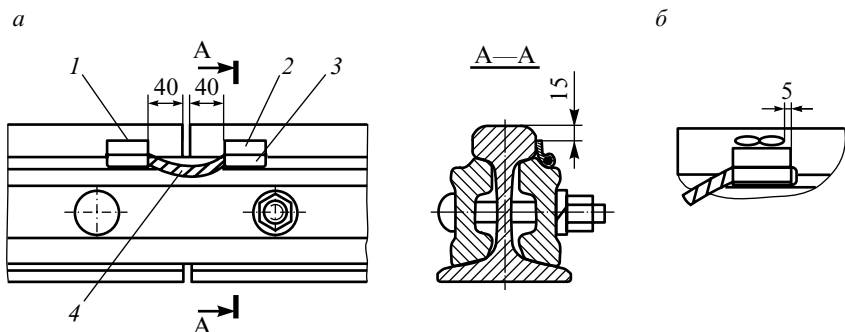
Схема установки (а) и приварки (б) медного соединителя фартучного типа к головке рельса:
